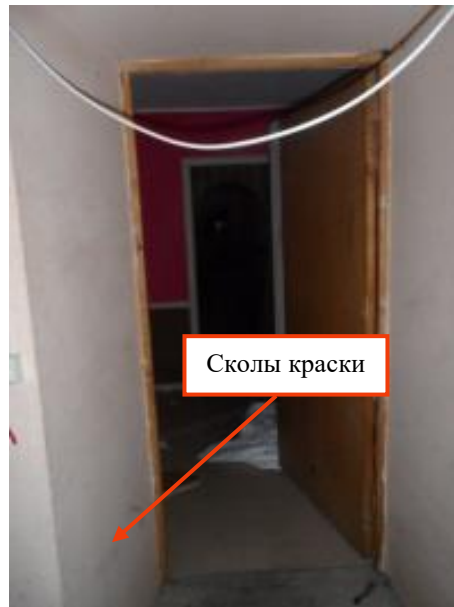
Вход в часть помещения №1 помещения 6-Н с первого этажа
